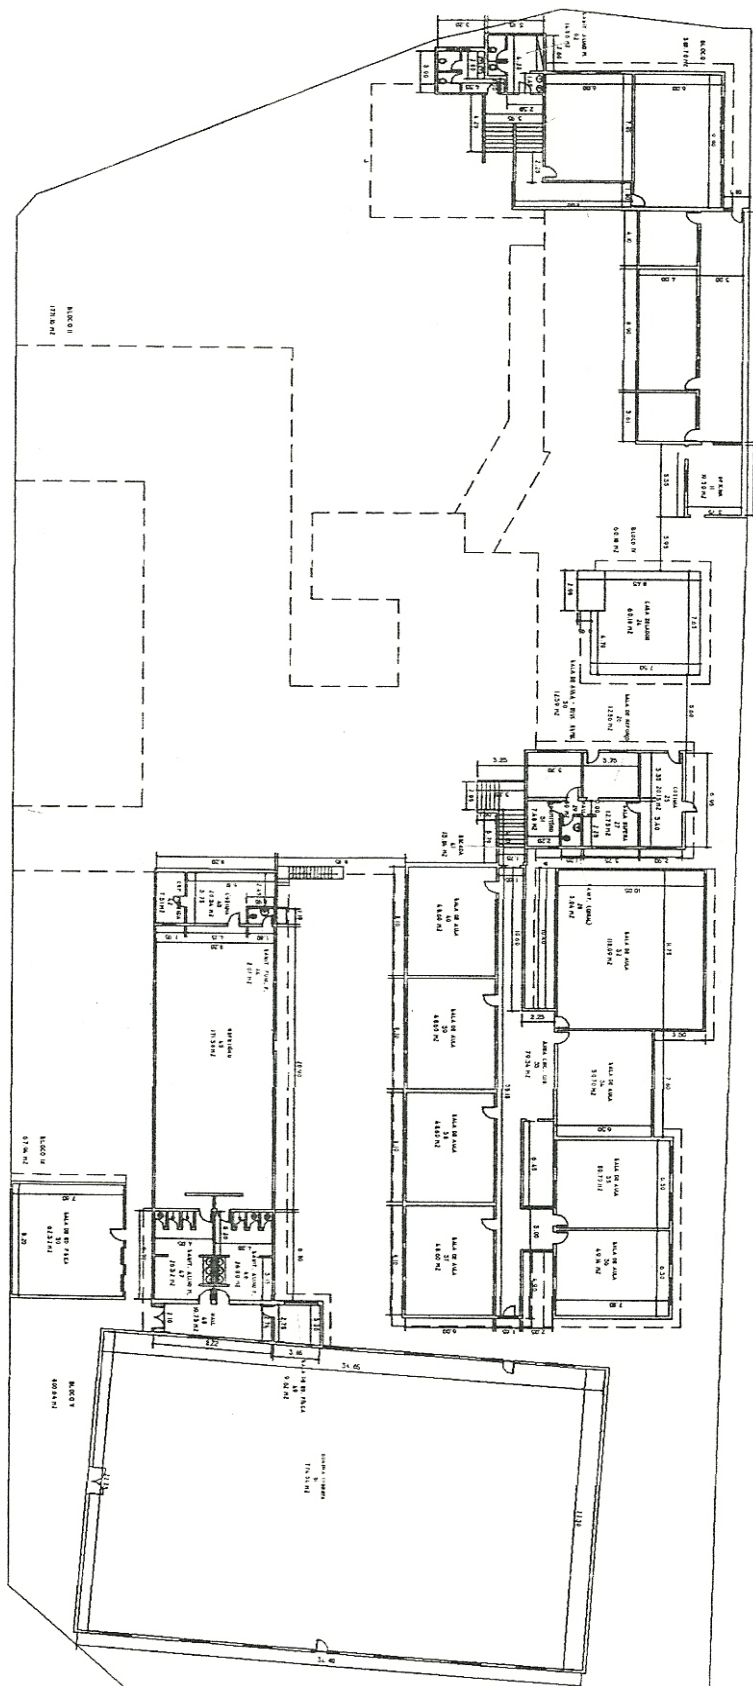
Cet Izidoro Luiz Cerávolo – Pavimento Térreo
